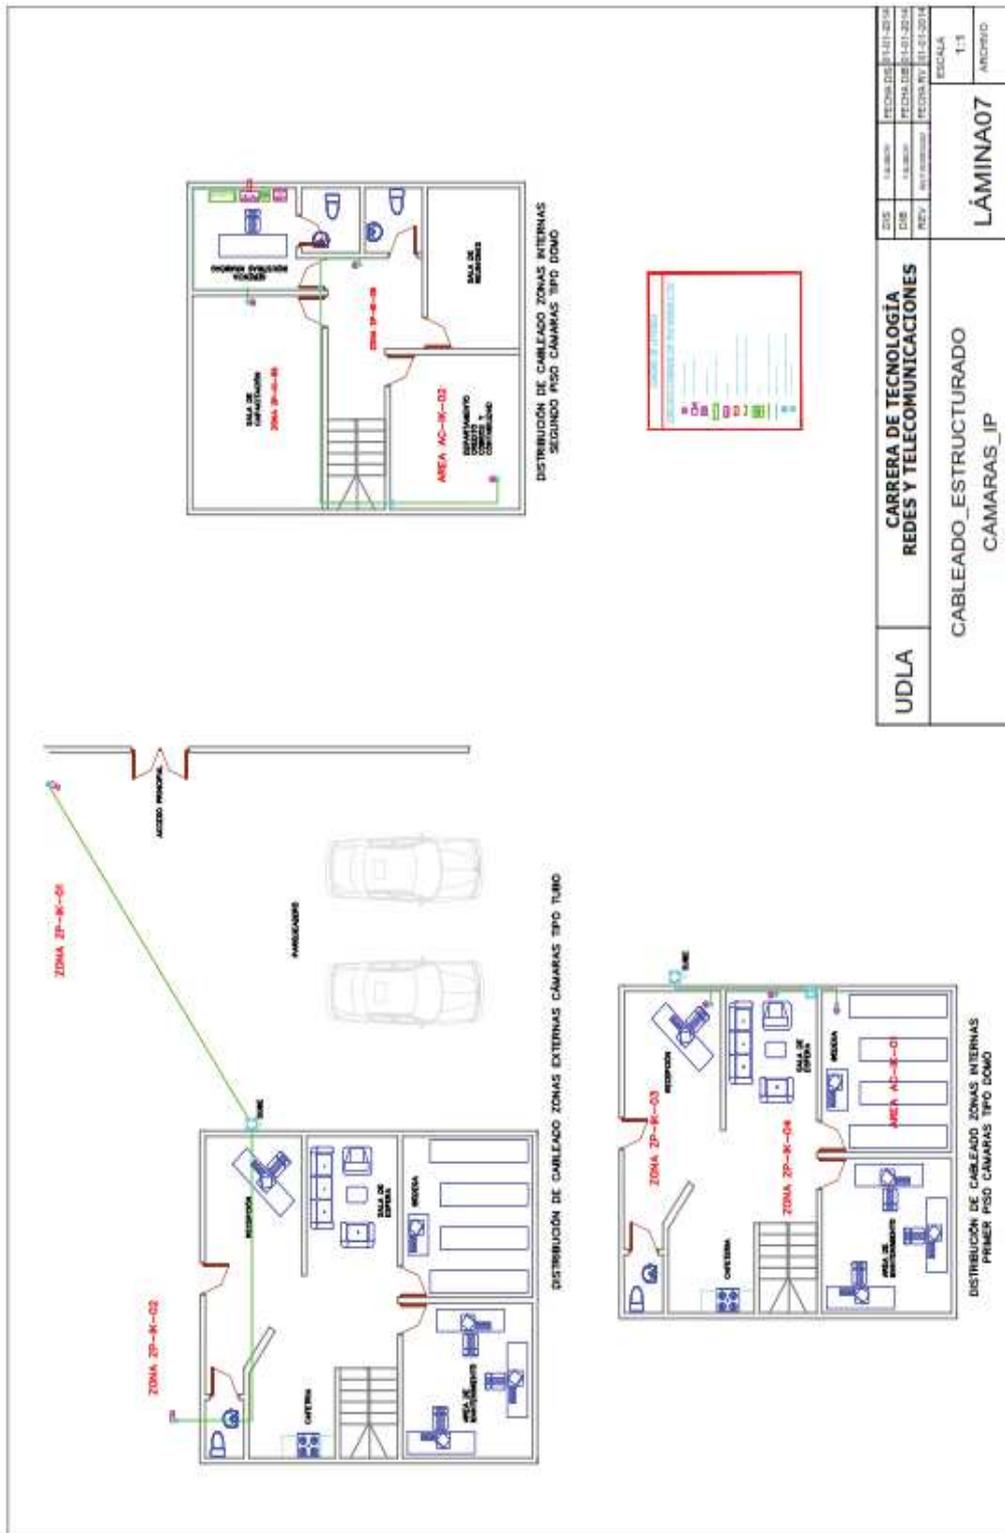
Distribución de Cableado Cámaras IP Zonas Externas e Internas
